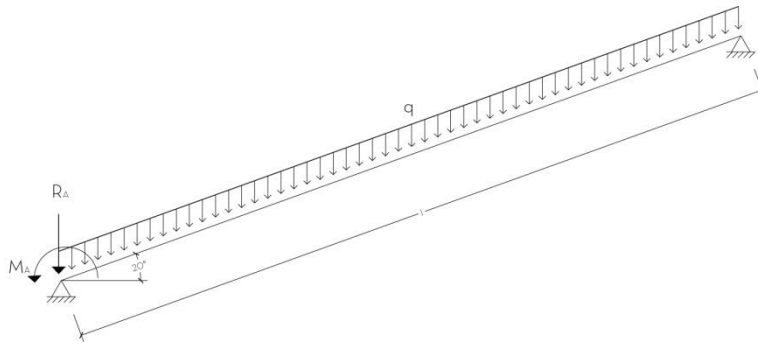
, Schema statico trave secondaria di copertura. Fonte autore tesi
